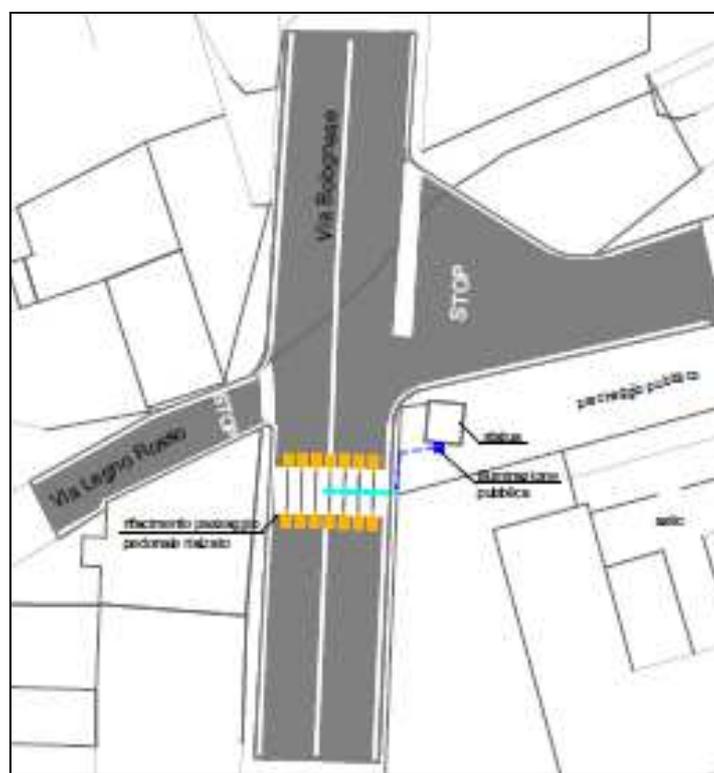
Stato di Progetto Via Bolognese int. Via Legno Rosso - Planimetria
